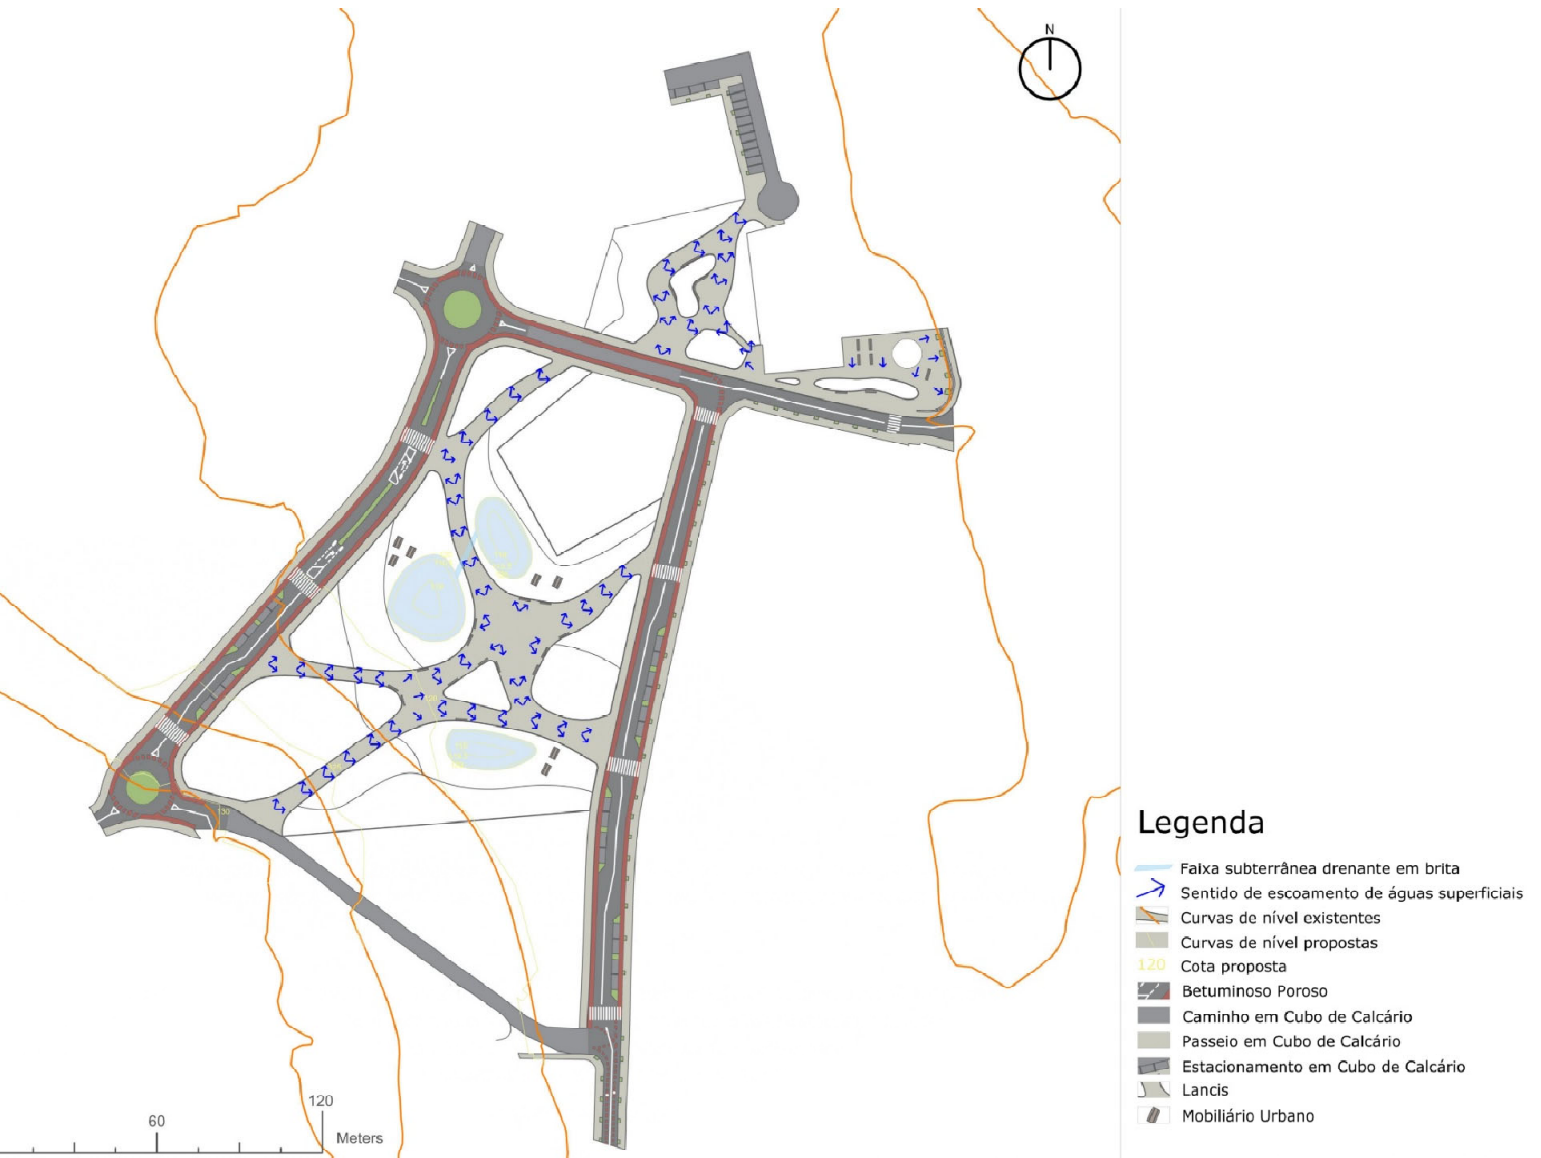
Plano de Pavimentos e Drenagem do Parque de Entre.Rios, Freixianda, Ourém
